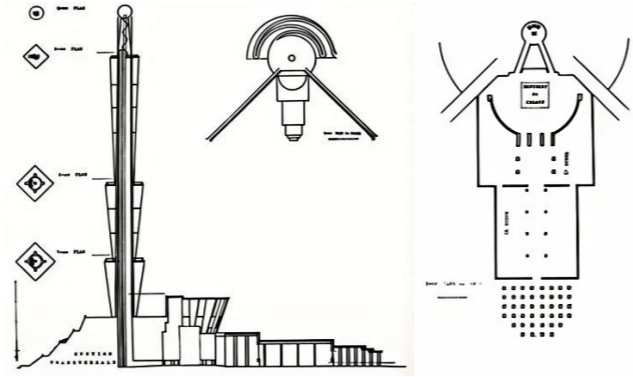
哥伦布纪念碑，竞赛方案，立面图、平面图，1929 年
